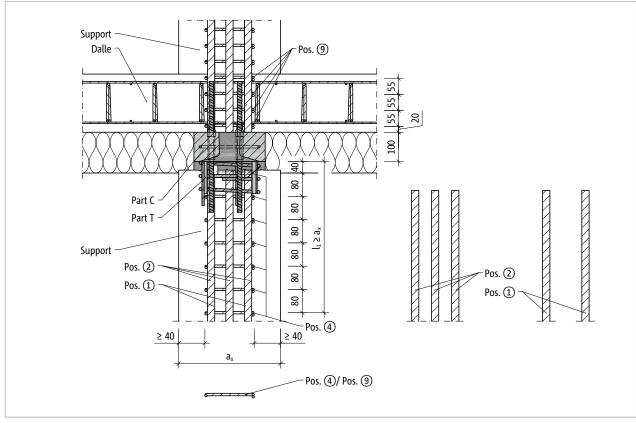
Schöck Sconnex® type P: renforcement sur site dans la coupe longitudinale A-A du poteau
